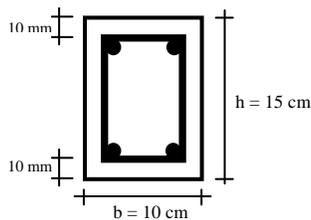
Struktur balok beton bertulang dengan pembebanannya
